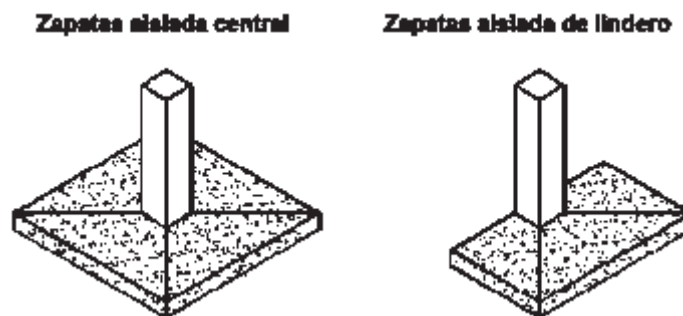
Zapata Aislada Fuente de consulta. <https://arqzon.com/2018/04/16/cimentaciones>
